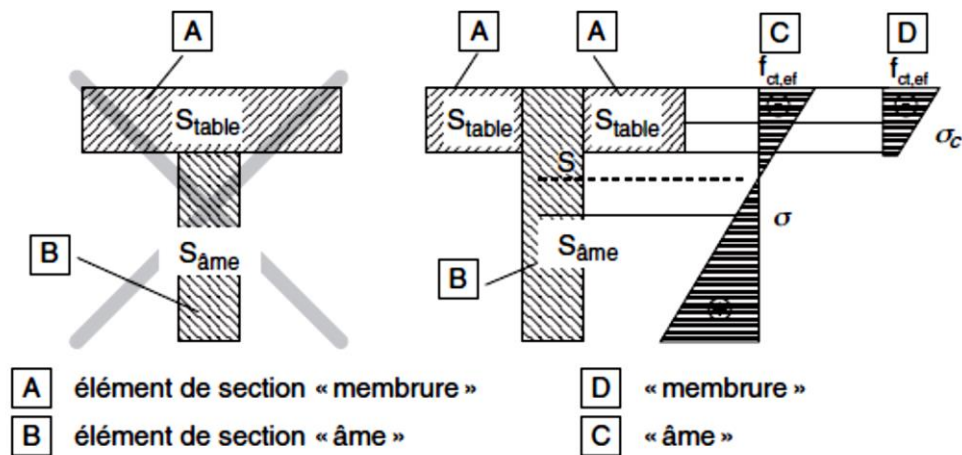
Découpage d'une section à membrures pour l'analyse de la fissuration
